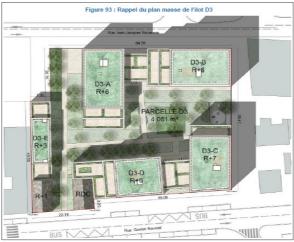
plan masse de l'îlot D3 (source étude d'impact)
